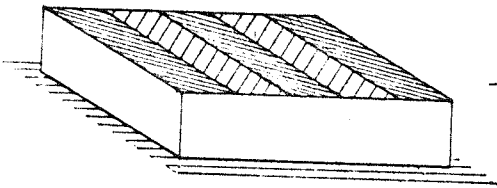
Las vigas de techo pueden funcionar como bielas entre los muros
